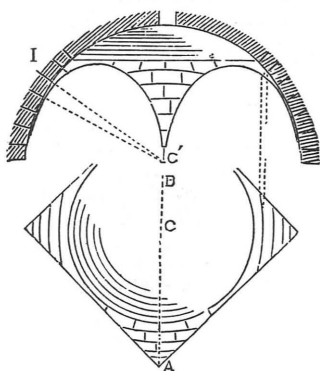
Ruinas de Gerasa. Planta y sección diagonal de la bóveda
